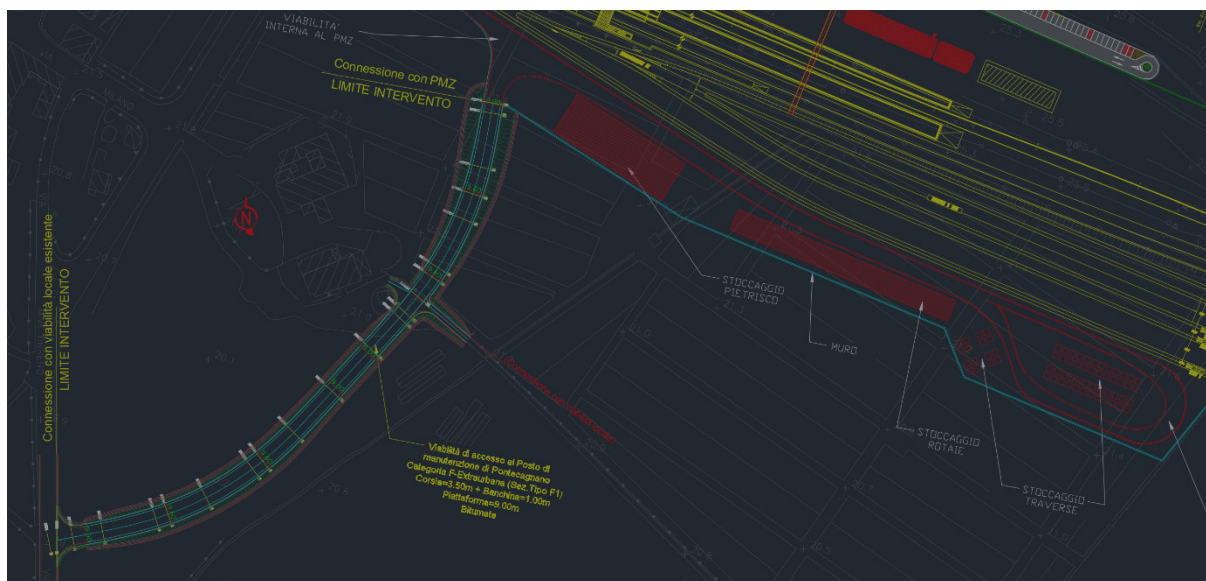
Stralcio planimetrico – NV07_Viabilità di accesso al PMZ di Pontecagnano
